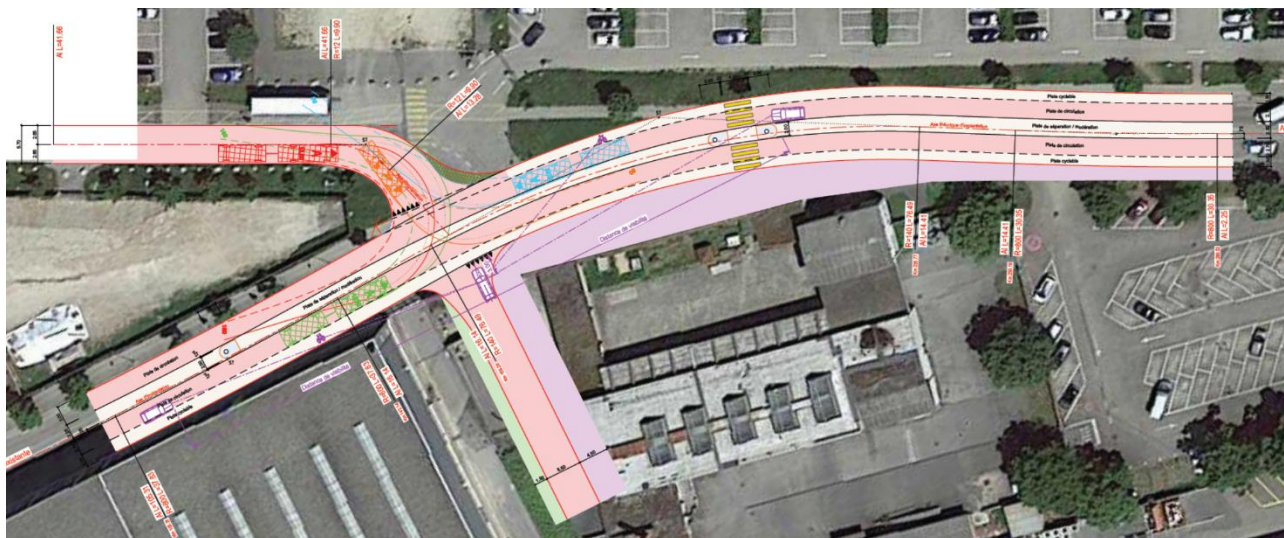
Extrait du plan d'aménagement du carrefour d'accès⁹
